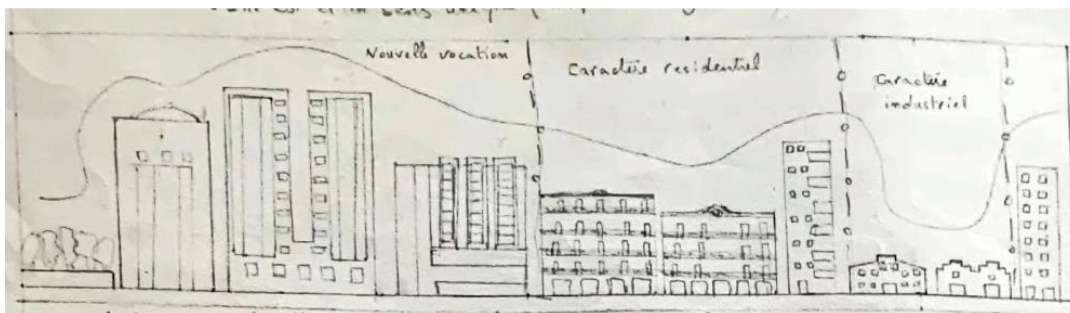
Façade sud de la rue Hassiba. (Source : auteur)
